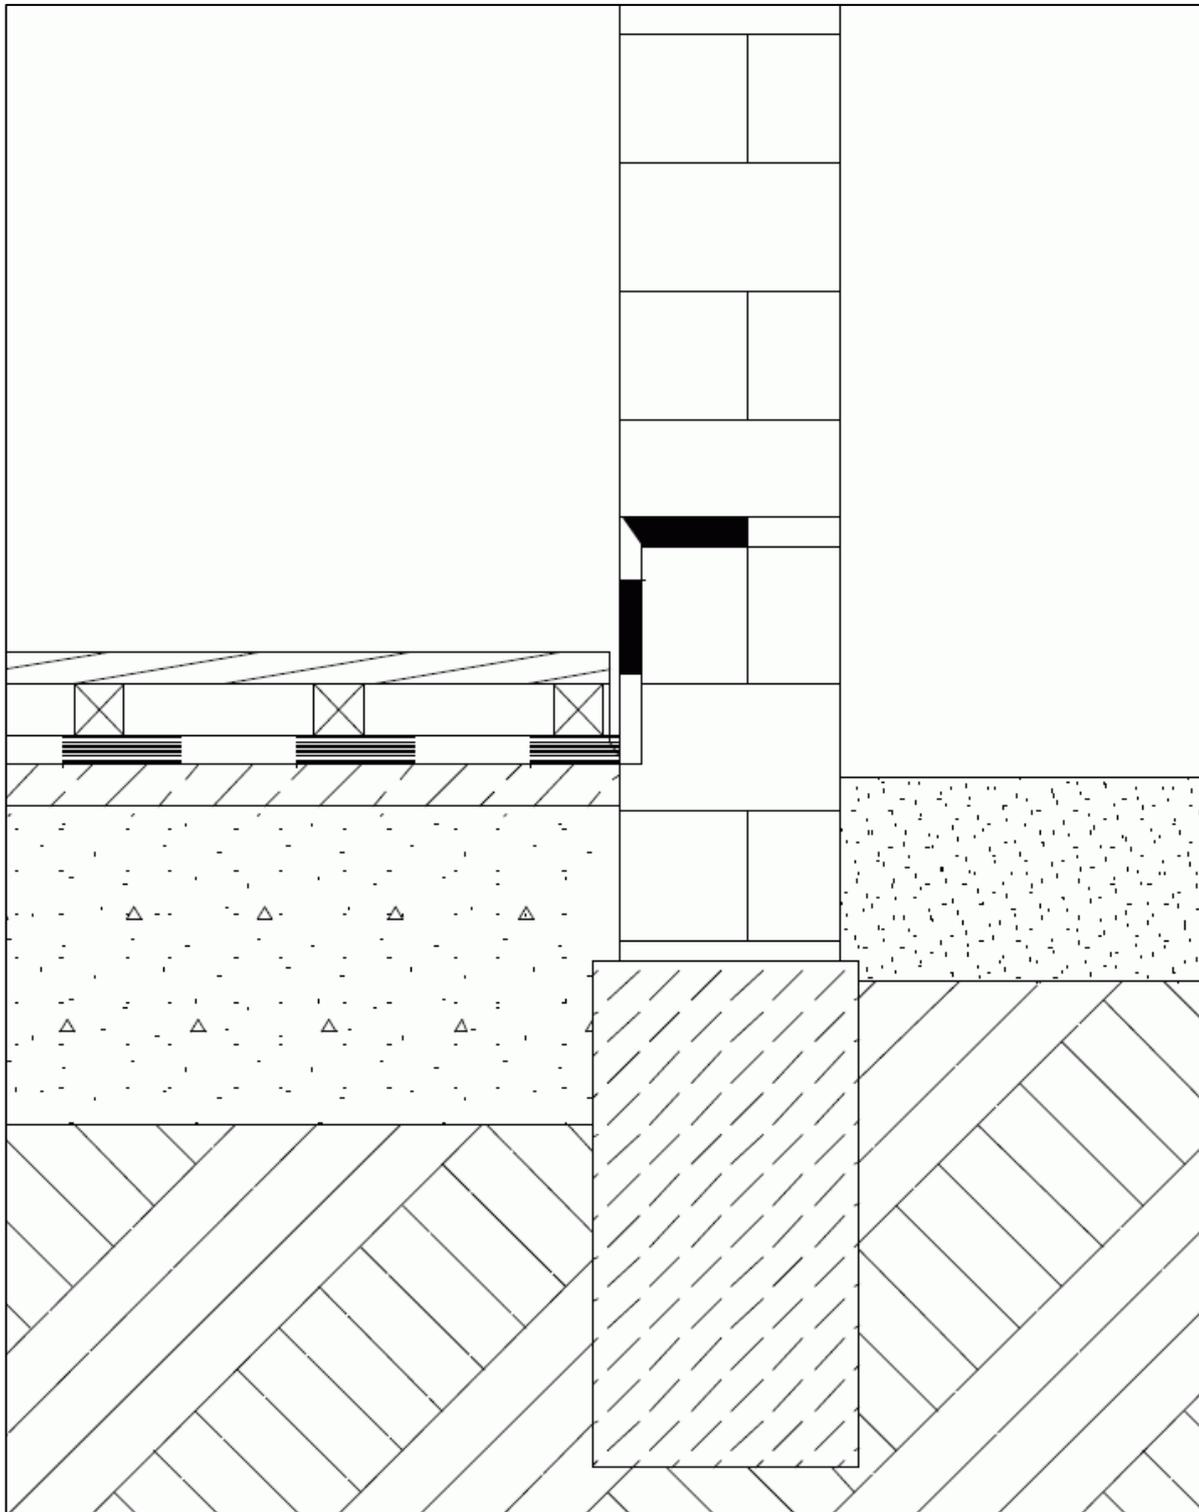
Holzdielung auf Lagerholz, mit nachträglich eingefügtem Unterbeton und Abdichtung
